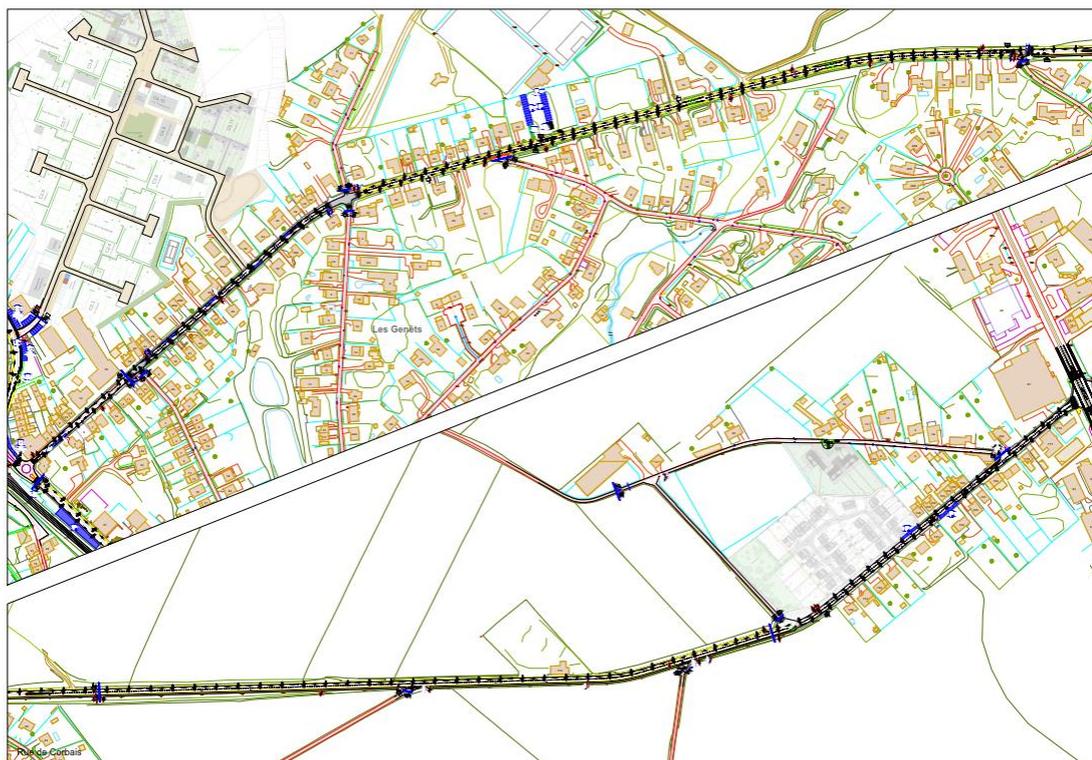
Zoom extrait du plan de détail de la rue de Corbais (voir plans pdf Rue de Corbais)
